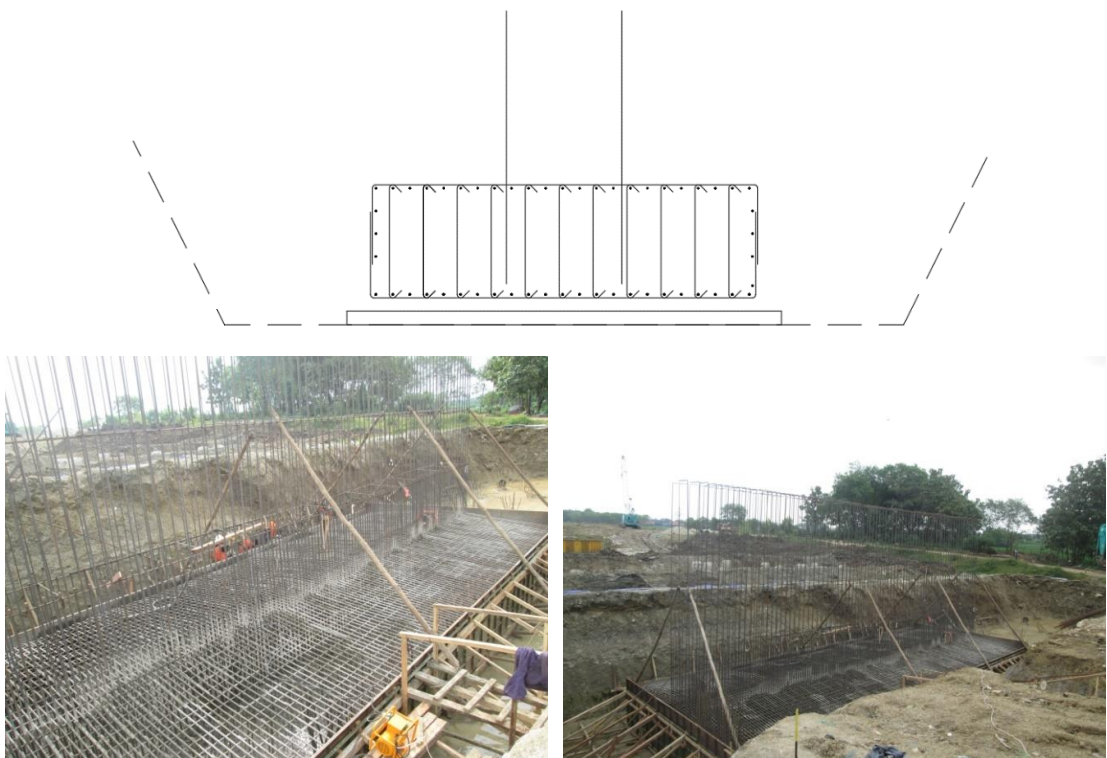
Lantai kerja pekerjaan *abutment
